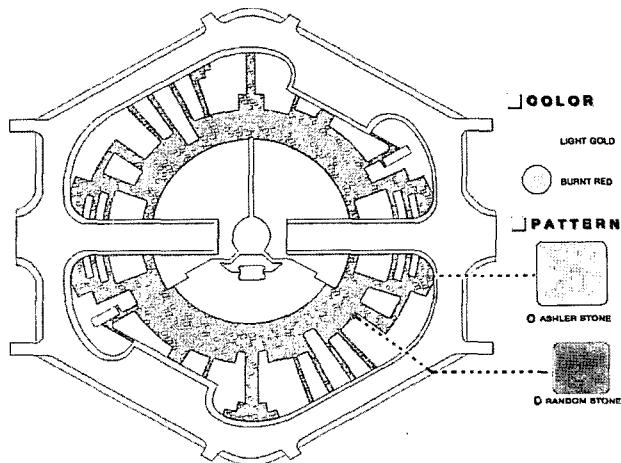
스템프 패턴을 이용한 칼라 콘크리트의 시공 예⁸⁾
